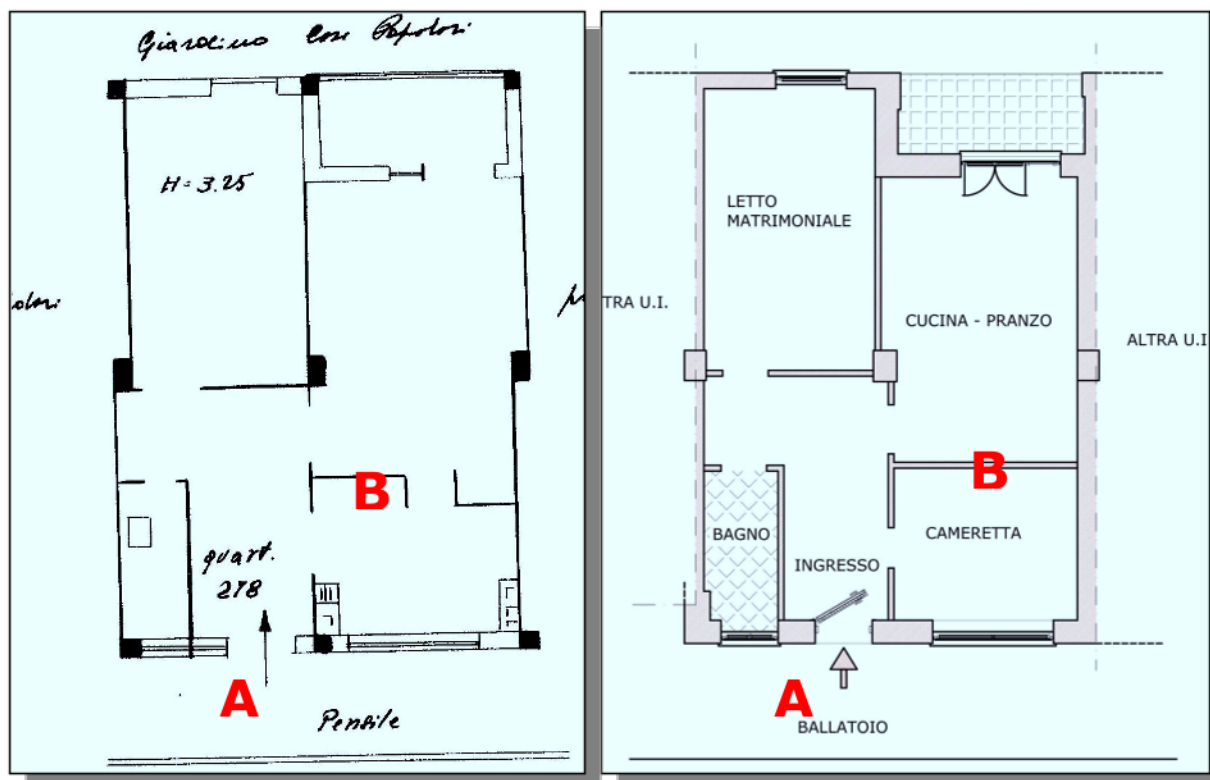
Criticità riscontrate nel raffronto tra la planimetria catastale (a sx) e lo stato attuale (a dx).
